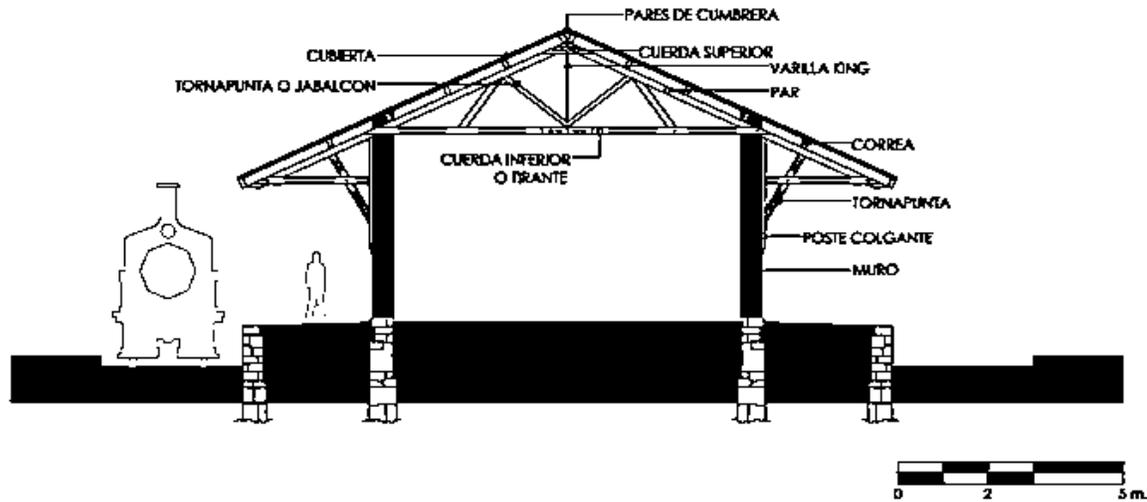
Sistema constructivo tipo de las estaciones, sección bodega de carga.
